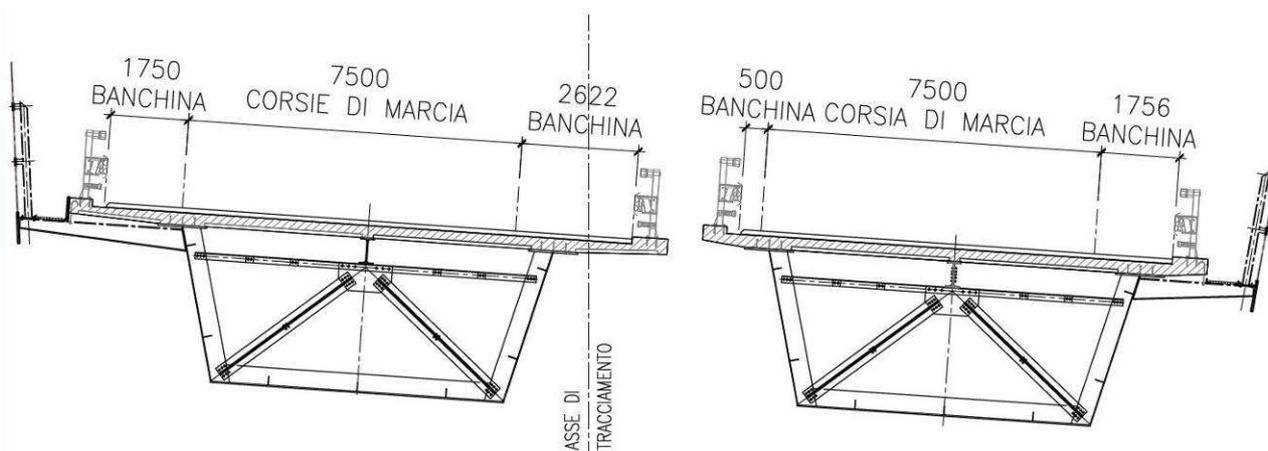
SEZIONE TIPO CAMPATA IN ACCIAIO VIADOTTO CROSTOLO (ESTRATTO DALL'ELABORATO T00VI01STRDI02A)
